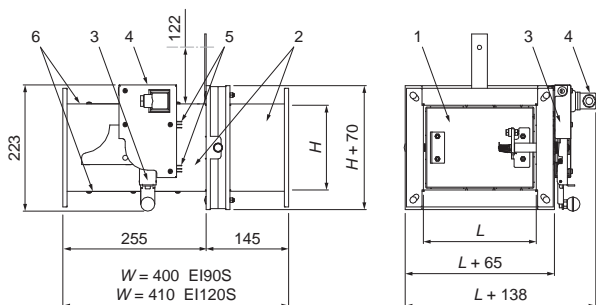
Конструкция малоразмерного противопожарного клапана с электромагнитным приводом для размеров из табл. 4
